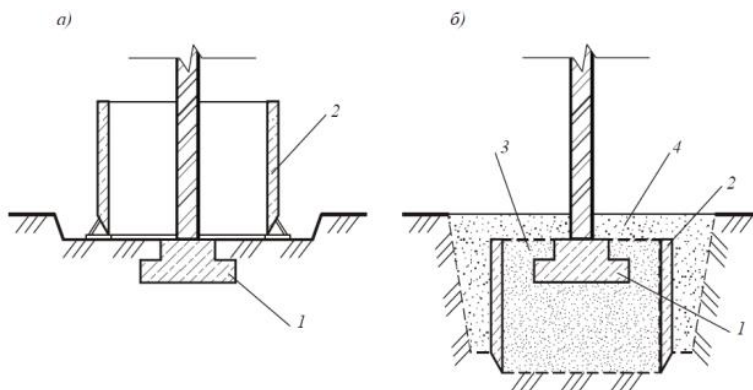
Усиление фундаментов с помощью опускного колодца: а-установка колодца в приямке на опоры, б-колодец в проектном положении: 1-фундамент, 2-опускной колодец, 3-обжимаемое основание, 4-котлован.
